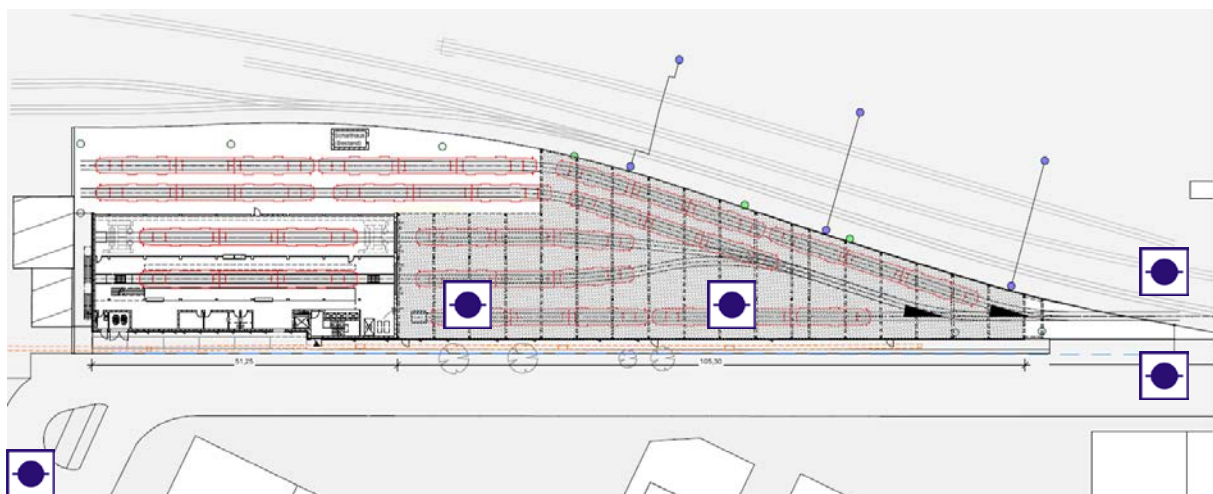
Ausschnitt aus Lageplan mit Löschwasserversorgung (momentane Lage im Bestand)
